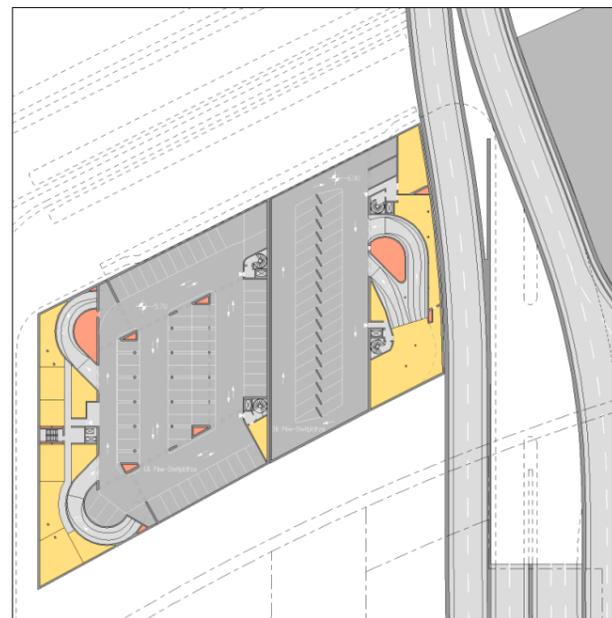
TG Variante 2 | 2. Untergeschoß
